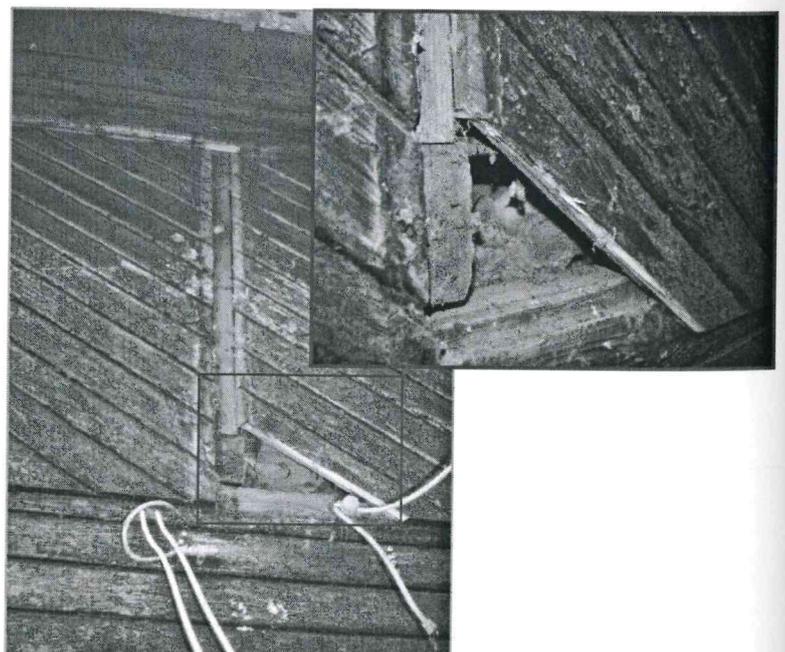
u. 11: Potentieller Fledermaus-Quartierbereich an der Ostfassade Haus I vor (Abb. links) und nach (Abb. rechts) dem Öffnen. Die Wände des Gebäudes sind hohl, jedoch sind keine Quartierzugänge vorhanden (Foto: H. SCHÜTT).
